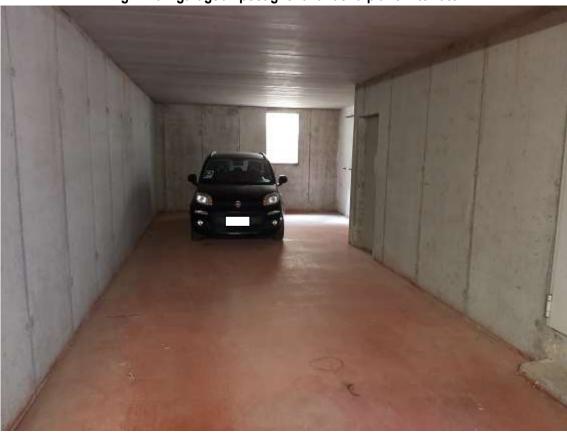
garage / ripostiglio-lavanderia piano interrato
